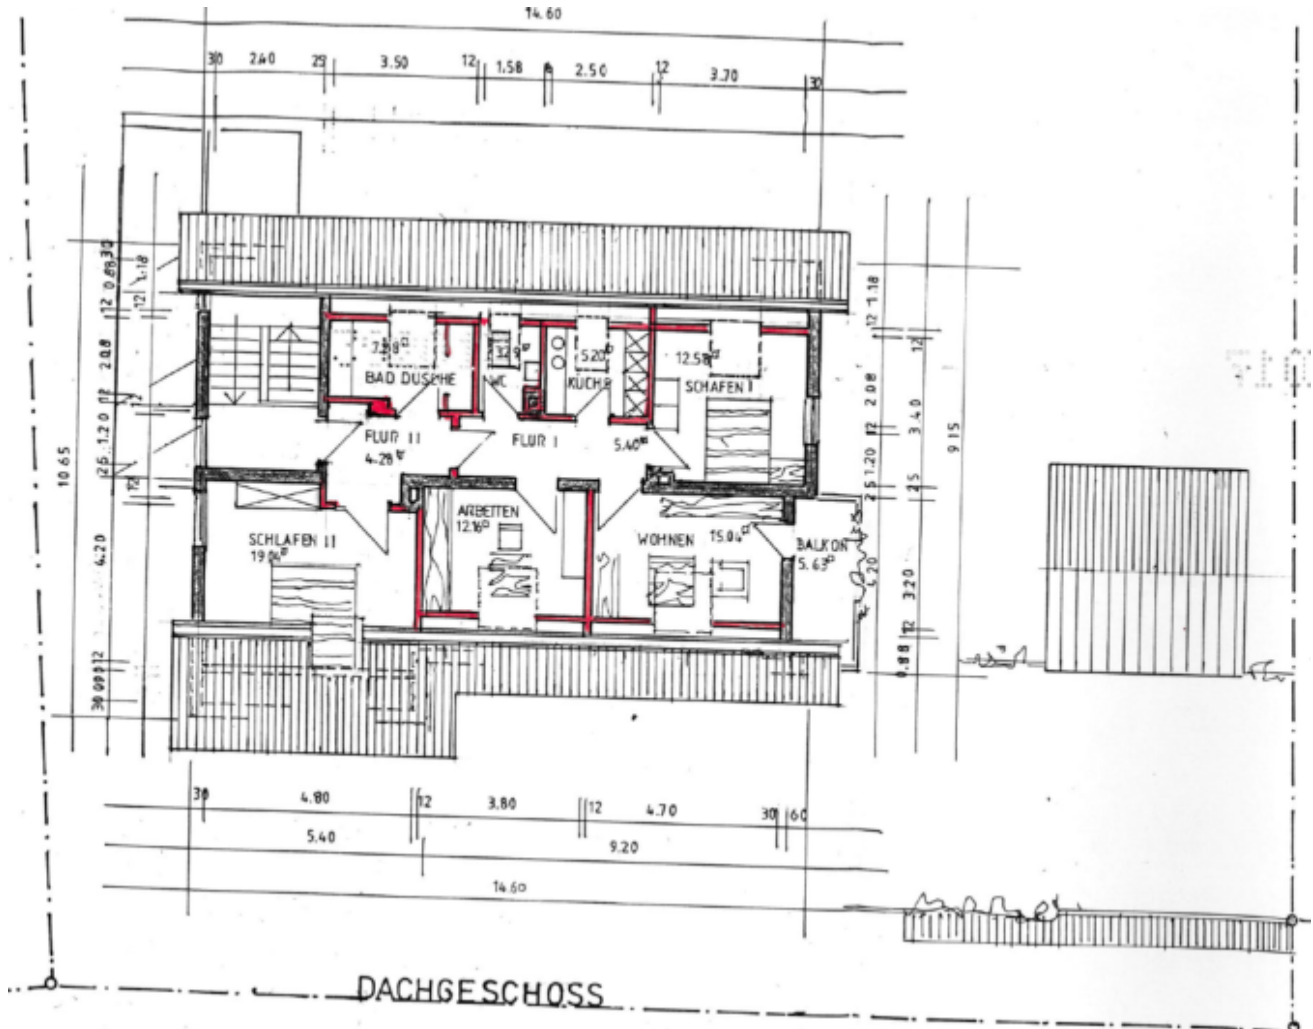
Grundriss Dachgeschoss; Quelle: Bauakte; Dachgeschossausbau Nachgesuch; 2017
